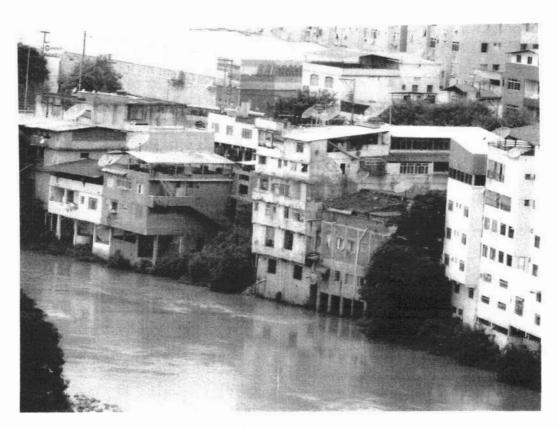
Vista aproximada em relação a foto anterior. Domicílios construídos em trecho suscetível a processos de solapamento. Estruturas construídas dentro da área de influência do Rio Piranga. Foto obtida no período seco.
